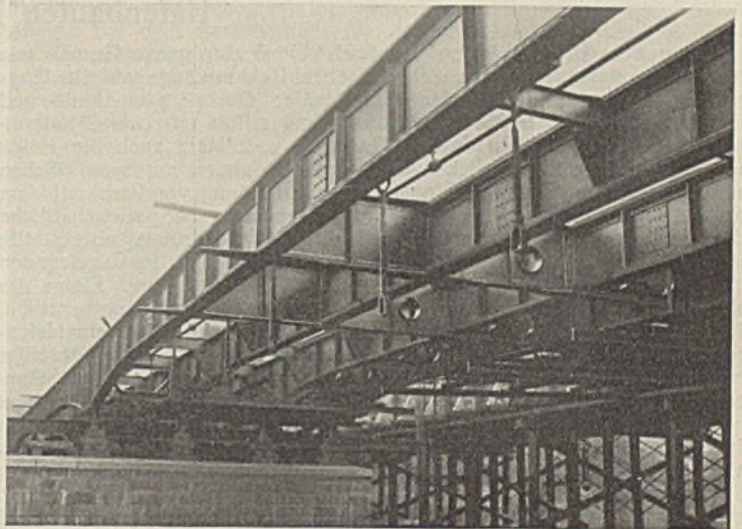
Hauptträgergruppe nach dem seitlichen Einfahren von der Baurüstung.
